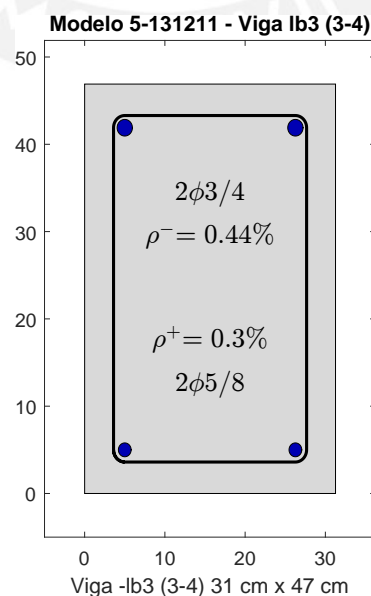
Sección resultante del diseño para vigas de concreto armado.
